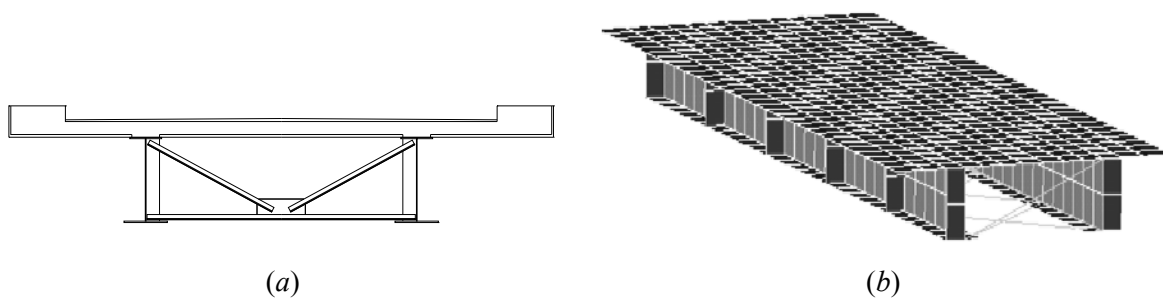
Ponte in struttura mista acciaio-calcestruzzo - sezione trasversali (a) e modello FEM (b).
